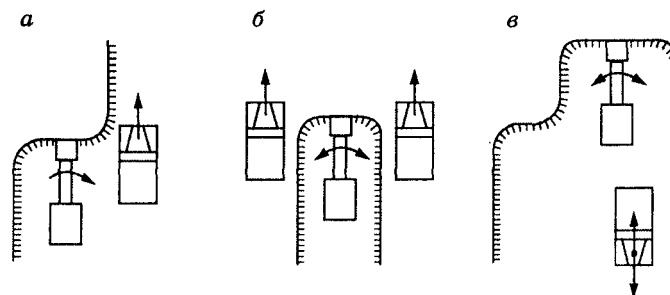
Схемы работы автомобилей с экскаватором: а — боковой забой; б — траншейный забой; в — лобовой забой
